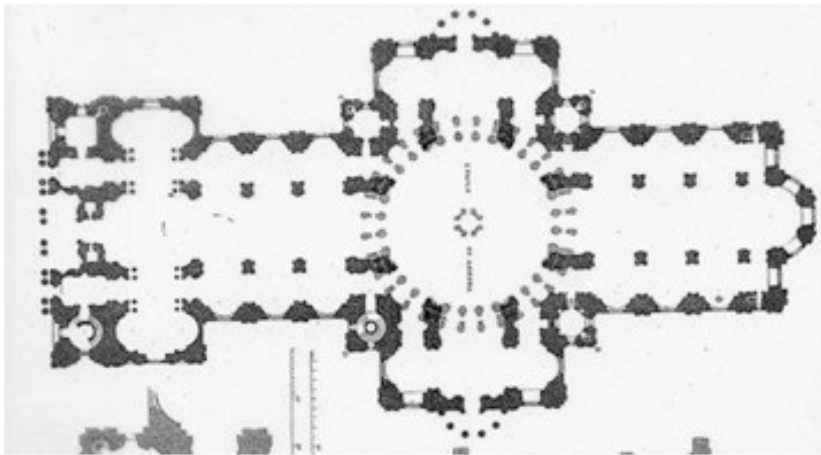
Pierre Patte e il suo confronto dimensionale. La pianta di Saint Paul a Londra.
